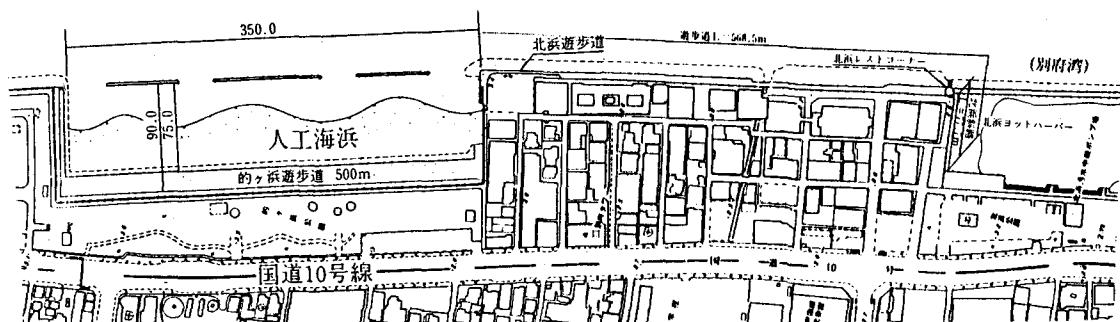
(2) 別府港北浜遊歩道・的ヶ浜人工海浜平面図
